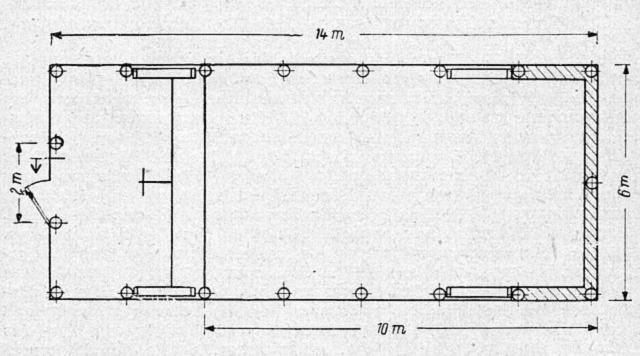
Grundriß für einen festen Luftgewehrschießstand
